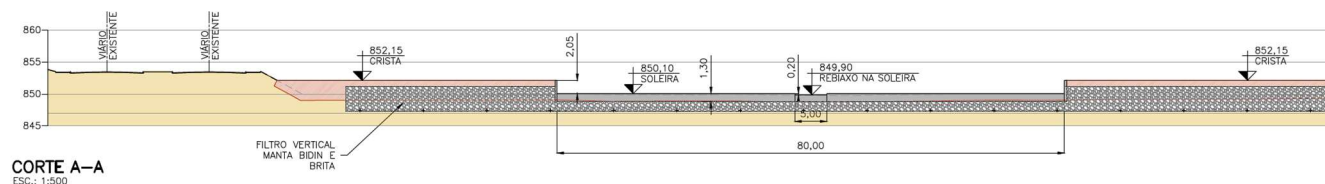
Seção proposta para o sistema extravasor da Barragem São Pedro
